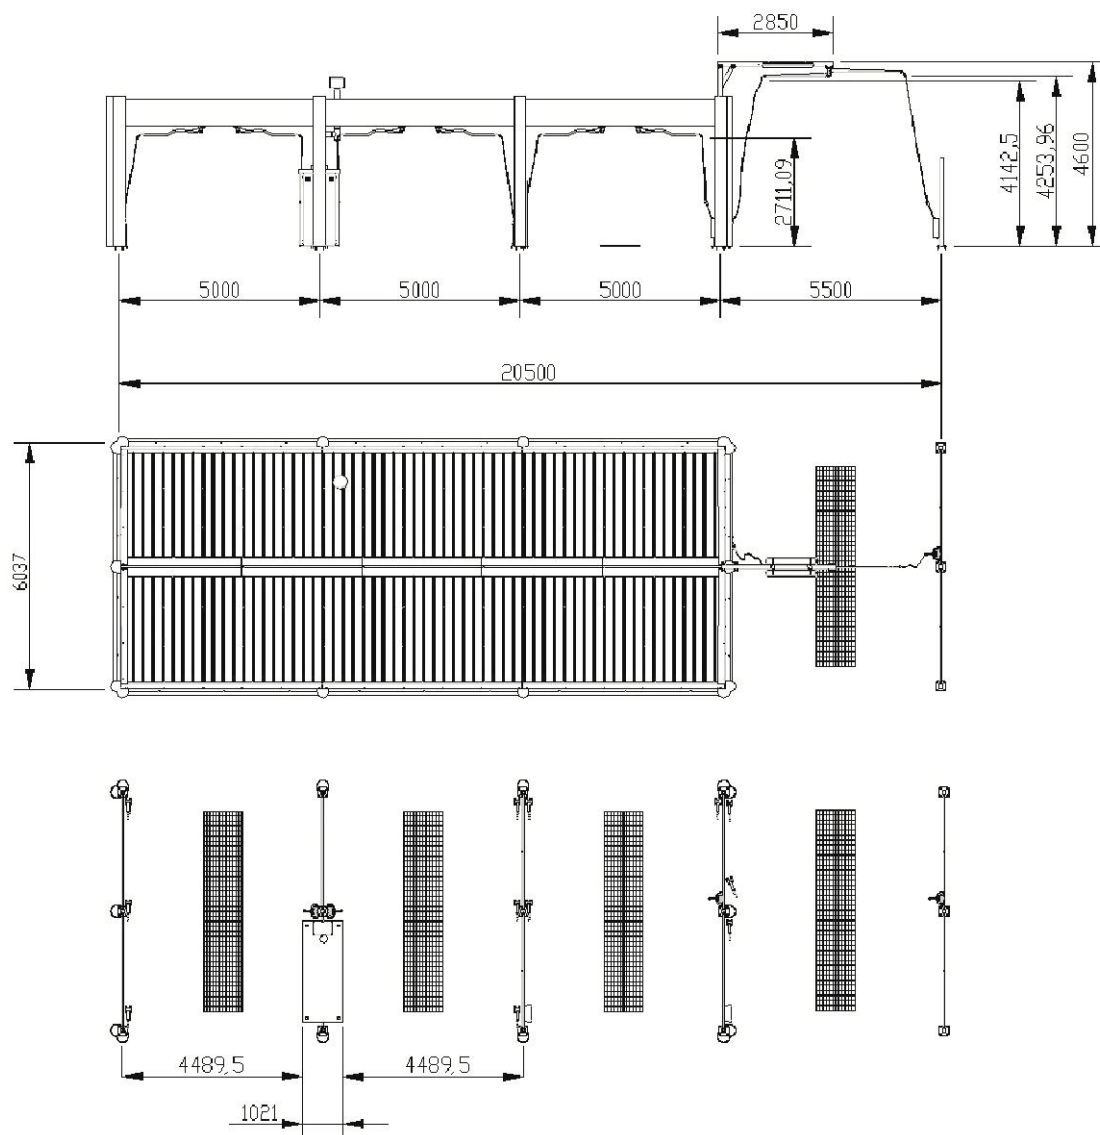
Dimensioni piste di lavaggi con armadio in acciaio inox
